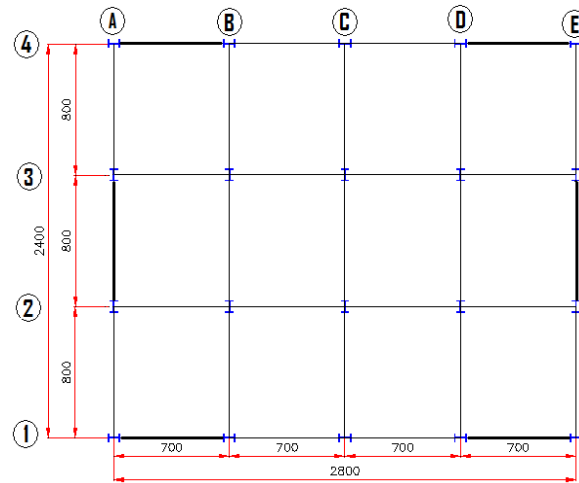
Dimensiones (cm). Planta Edificios de 6 Niveles.
